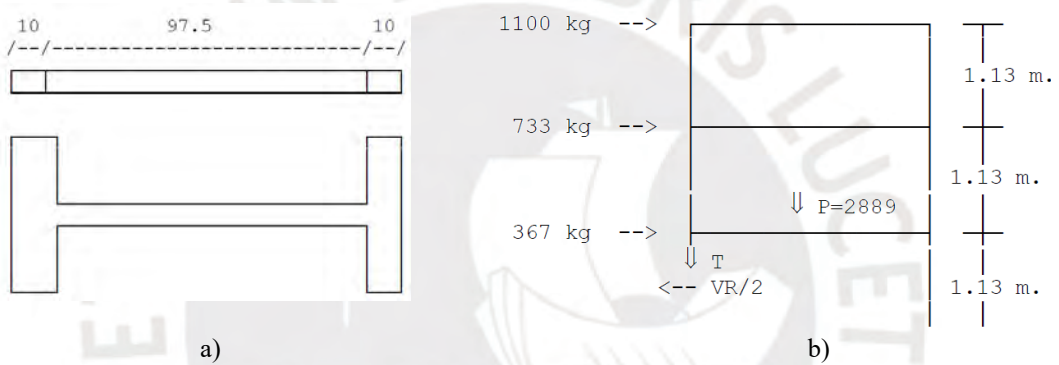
Muro del espécimen ensayado a) vista en planta sección bruta y transformada, b) Elevación y detalle fuerzas estáticas [32].
